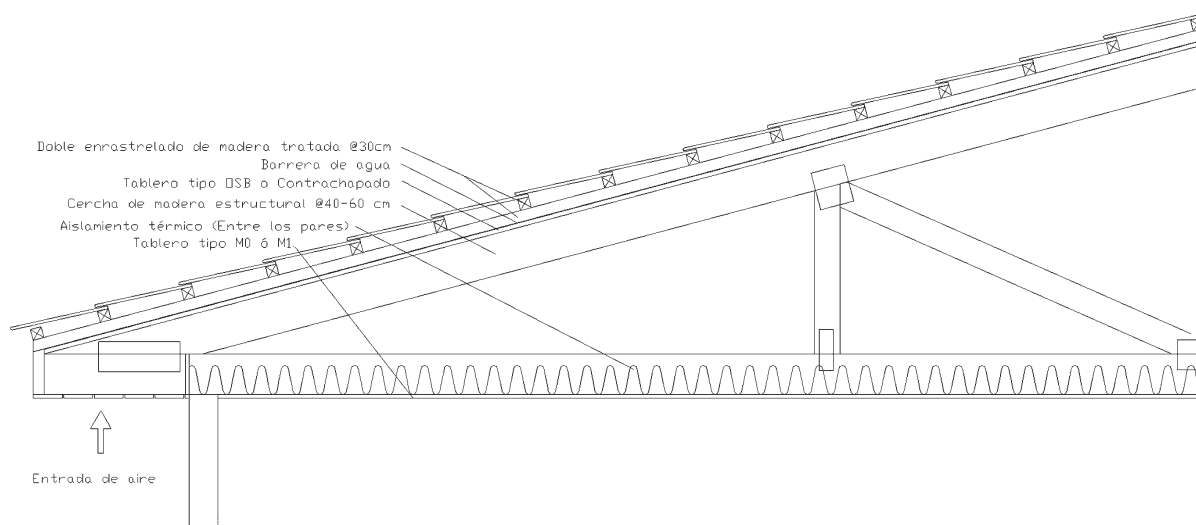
Detalle del sistema constructivo más habitual de entramado ligero con elementos compuestos.
